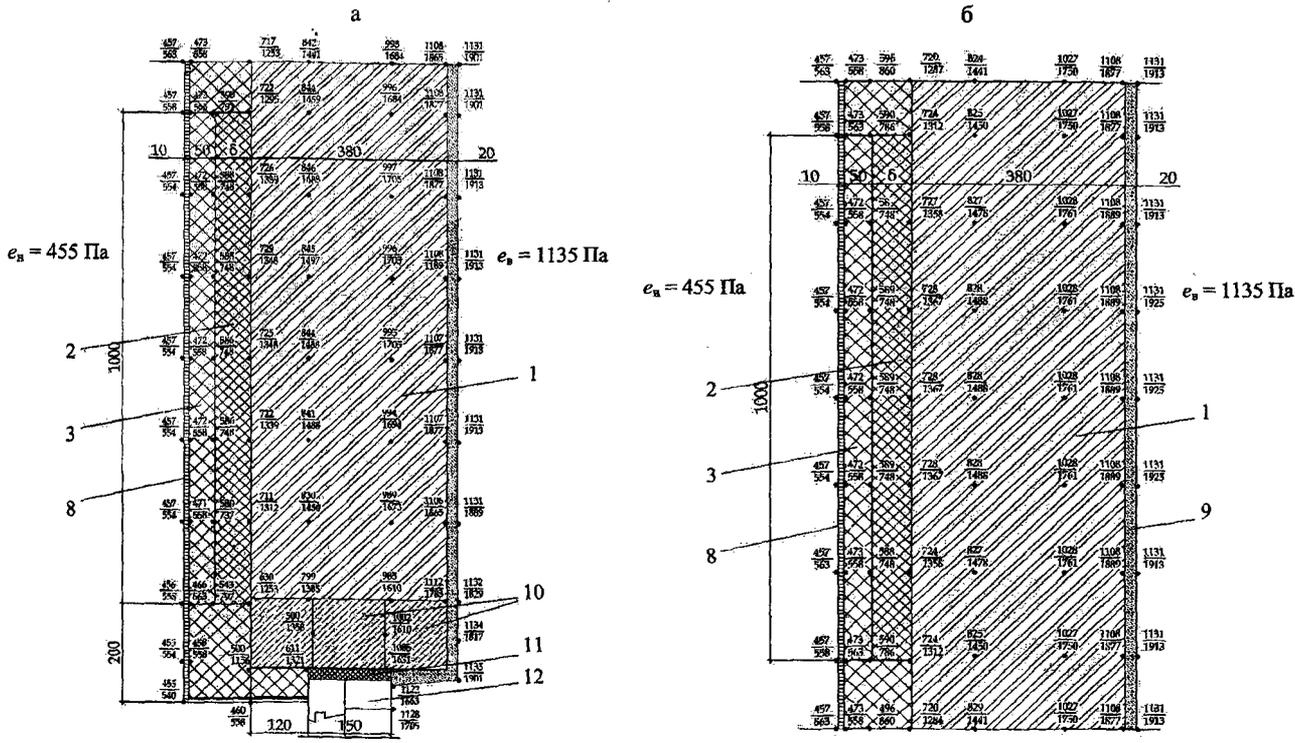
Влажностное поле: а – узла сопряжения наружной стены с заполнением оконного проема; б – наружной стены (обозначения – на рис. 3)
